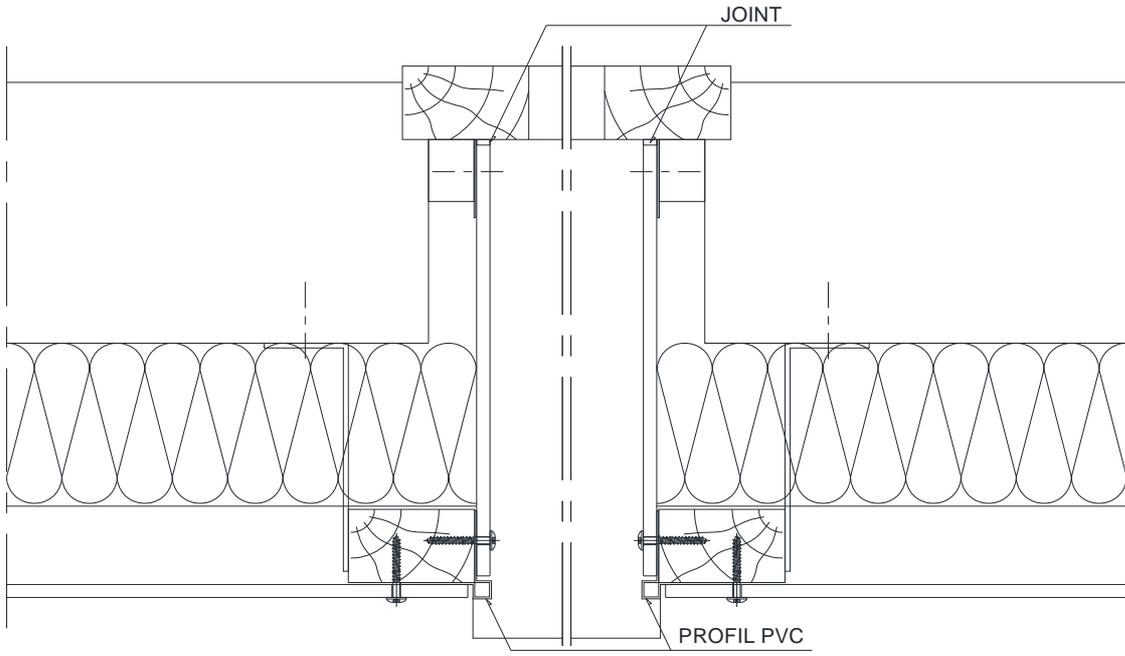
Encadrement de baie sans isolation complémentaire - Coupe horizontale - Pose en bardage
